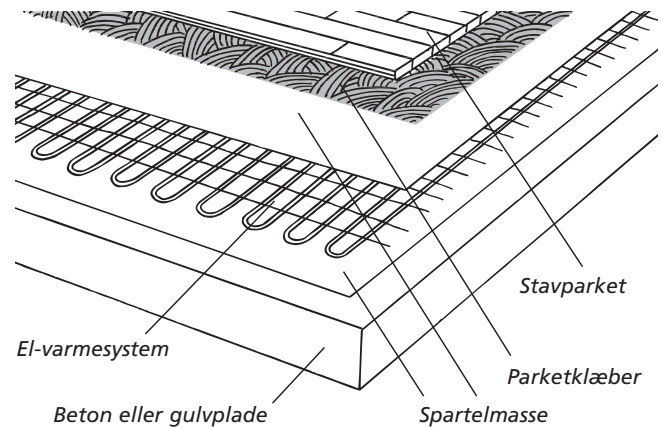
Tegningen viser betondæk med elvarmesystem og Timberman Stavparket.
